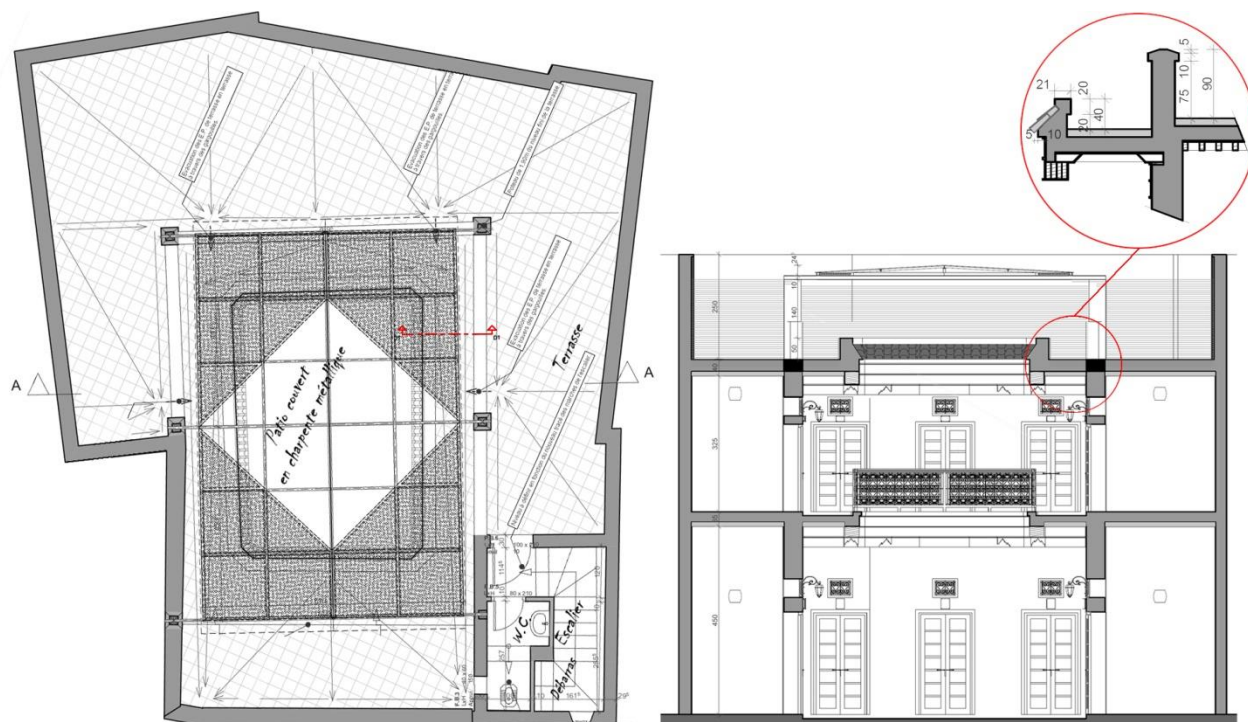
Planta de la azotea. Sección, detalle de la cubierta. Imagen cedida por Rida Hbibí
